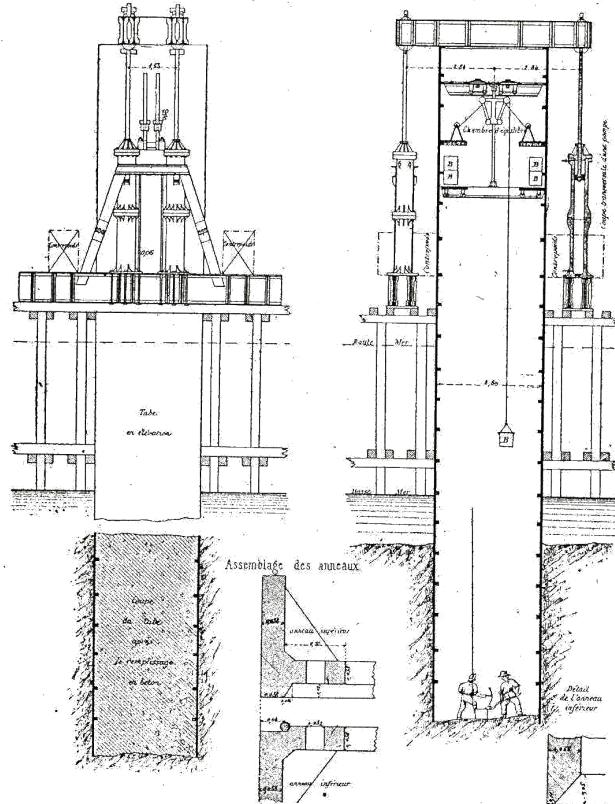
Fondations du pont sur la Garonne, à Bordeaux.
